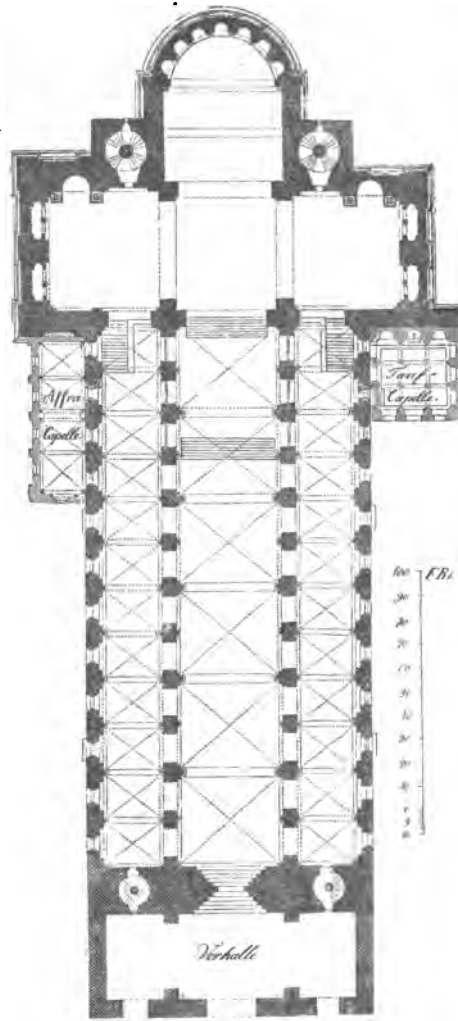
Dom zu Speyer, Grundriss.
